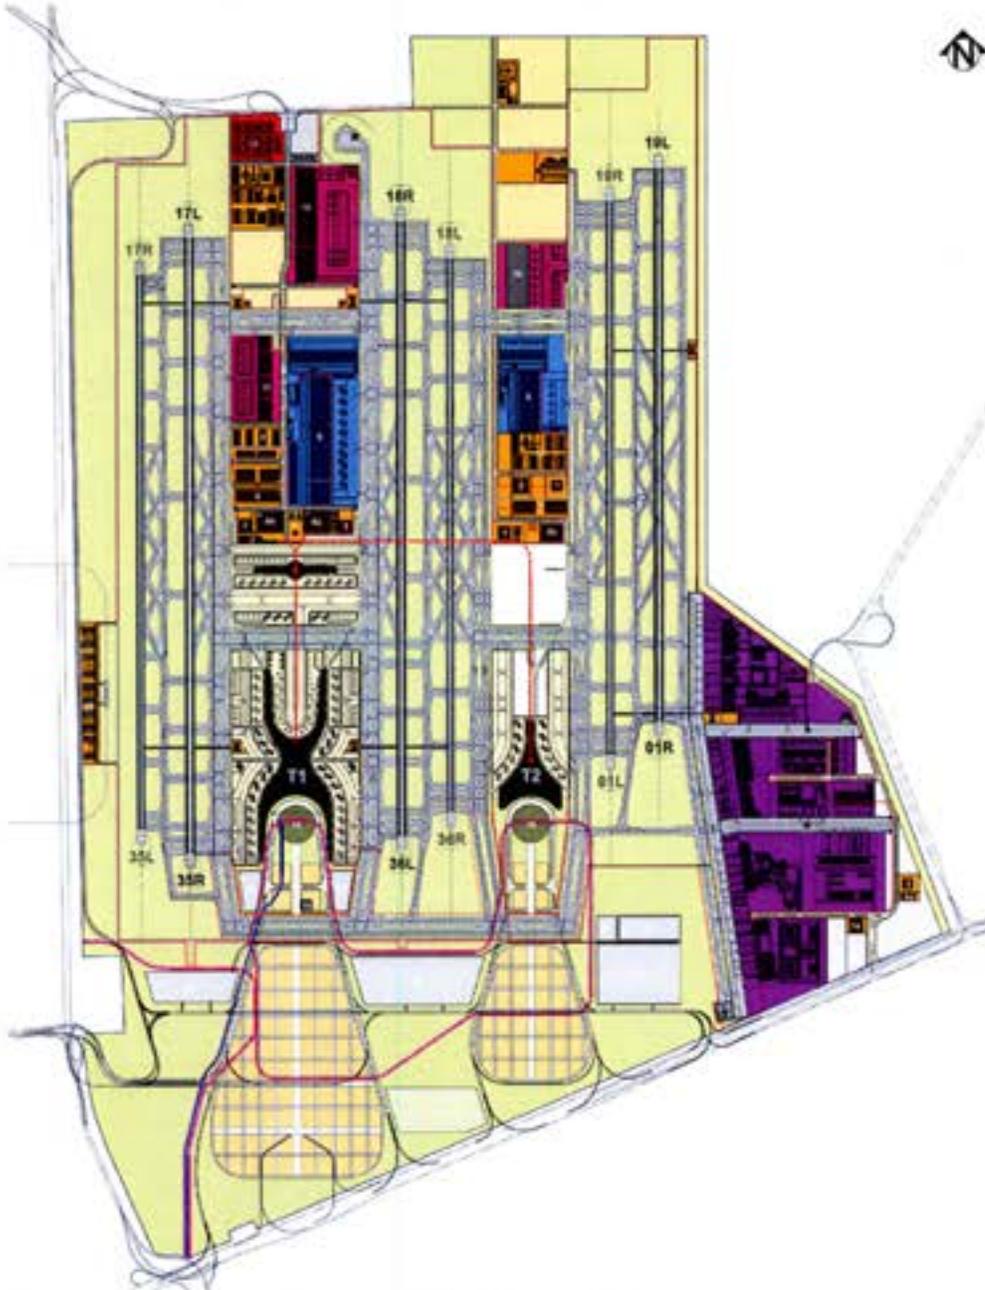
Esquema del Aeropuerto | Plan Maestro 2065
